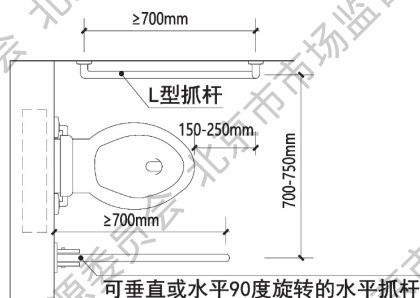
无障碍坐便器 L 型安全抓杆设置平面图
